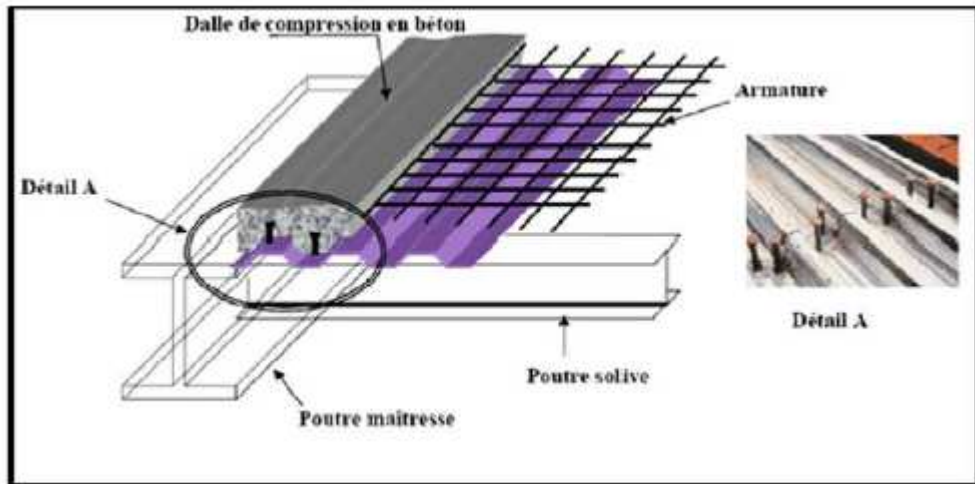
Plancher mixte avec des connecteurs acier-béton
